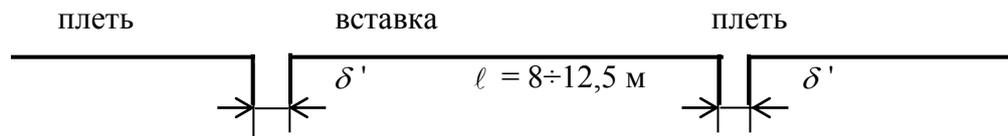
Схема варки рельсовой вставки алюминотермитной сваркой
